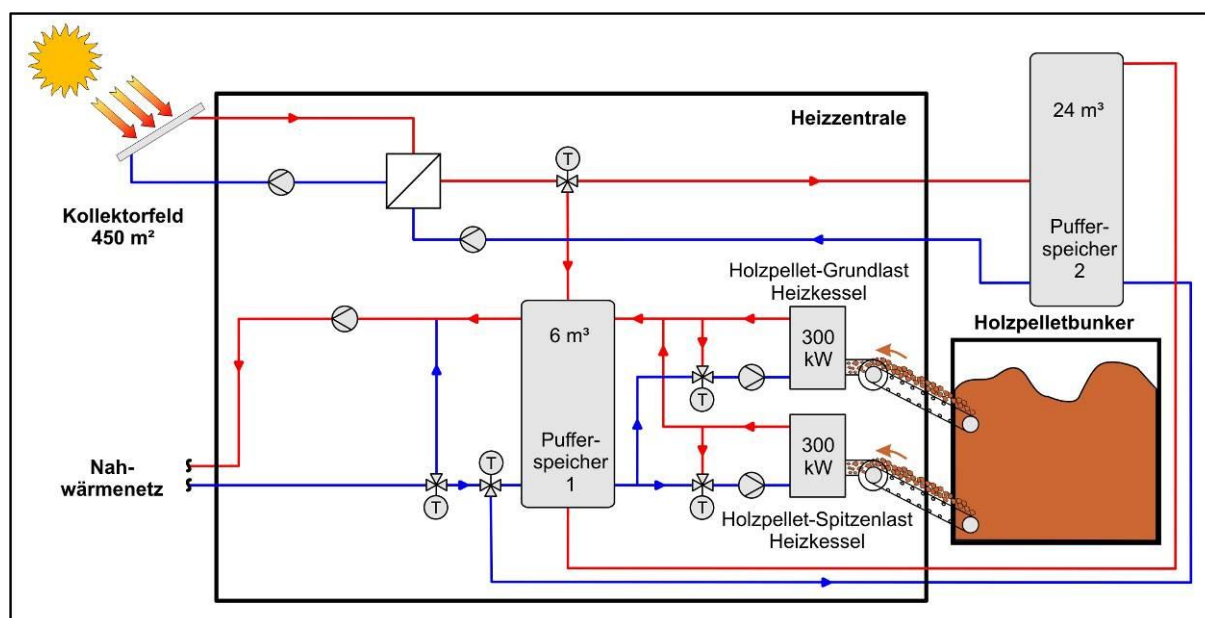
Anlagenschema Variante 3b – Holzpelletkessel mit Solaranlage 450 m²
